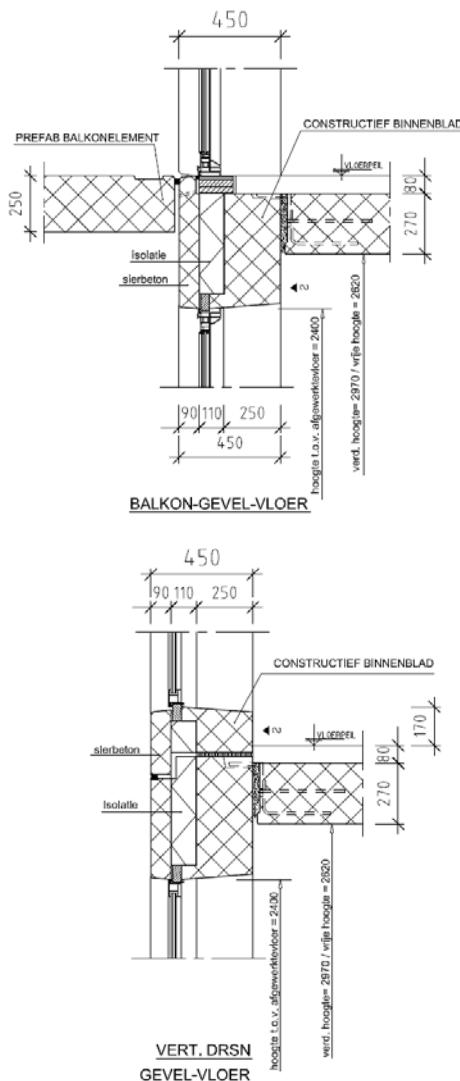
Voorbeelddetails van een woongebouw en prefab vloervloeren inclusief leidingen voorzien van stalen handen
